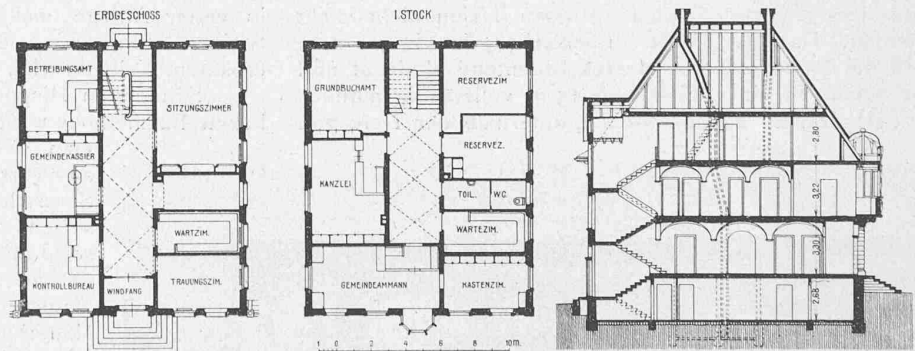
Lageplan 1:1500. — Abb. 2 bis 4. Grundrisse und Schnitt. — 1:400.
